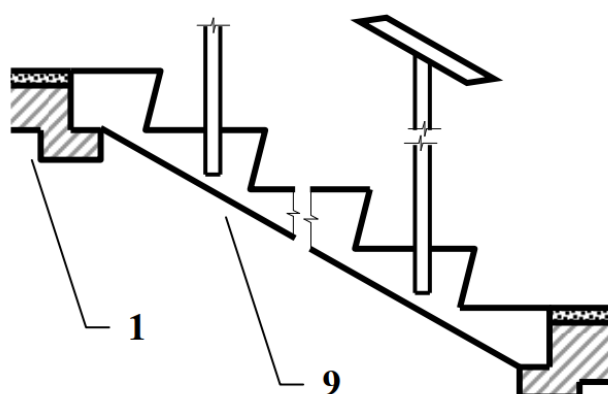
Приклади влаштування великоелементного сходового маршу: 1 – площадочна плита; 9 – сходовий марш
